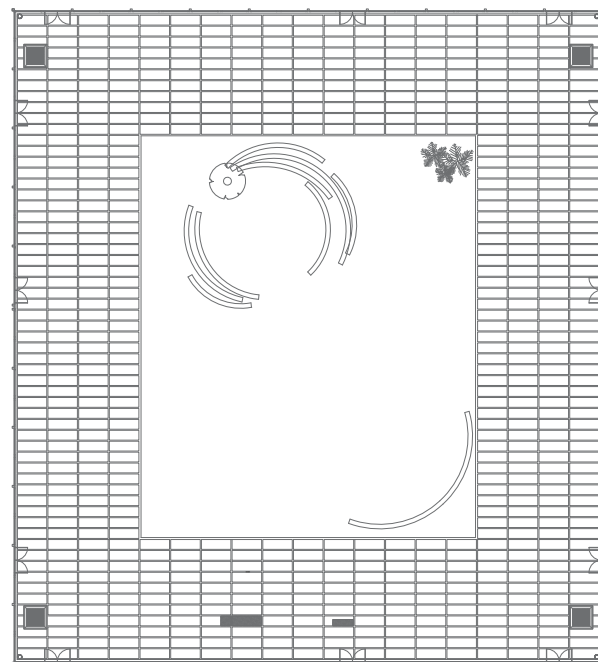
Pavimento con juntas rellenas de hormigón de árido visto
